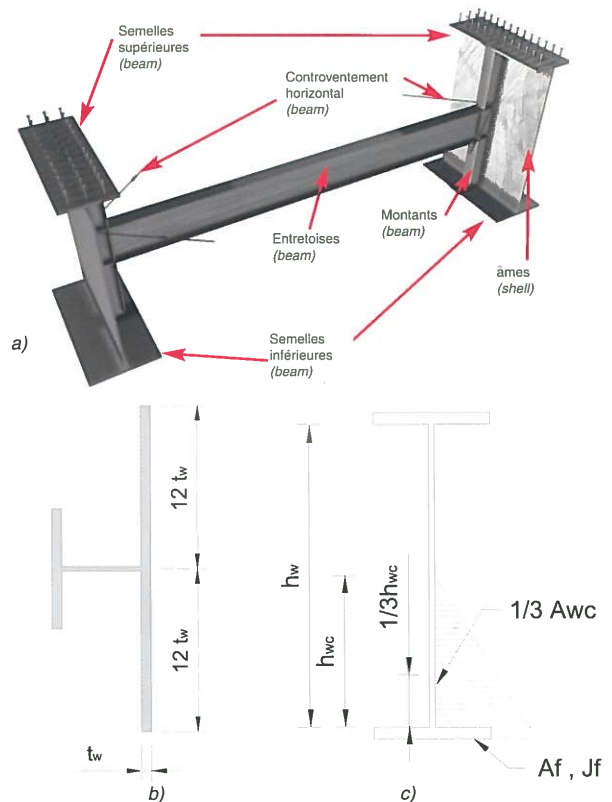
a) Modélisation EF des parties acier en coques (shell) et en poutres (beam), b) section montant, c) section semelle / a) FEM of steel parts in shell and beam elements, b) vertical support stiffener, c) flange section
